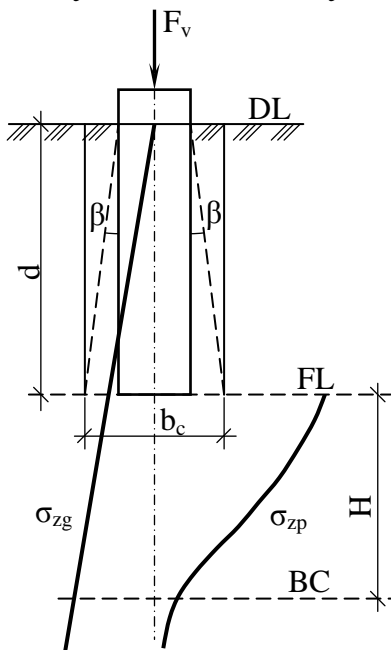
Розрахункова схема осідання фундаменту, споруджуваного без виймання ґрунту
